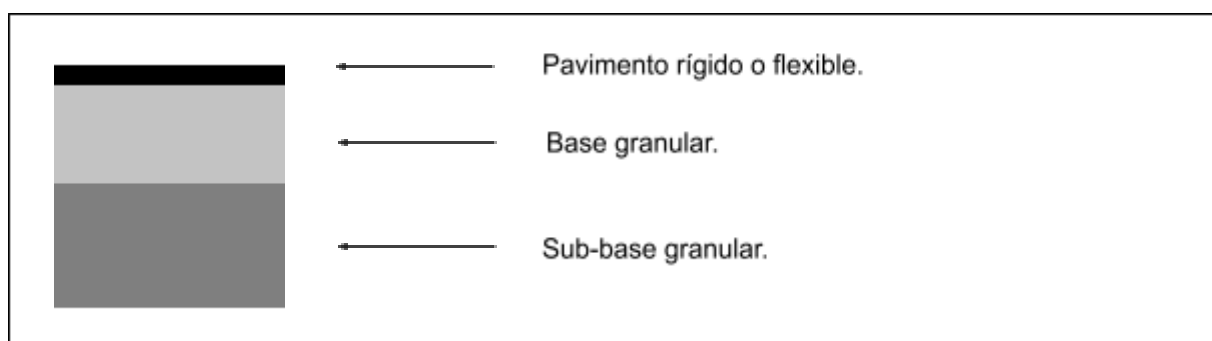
Esquema de la estructura de un pavimento flexible.
